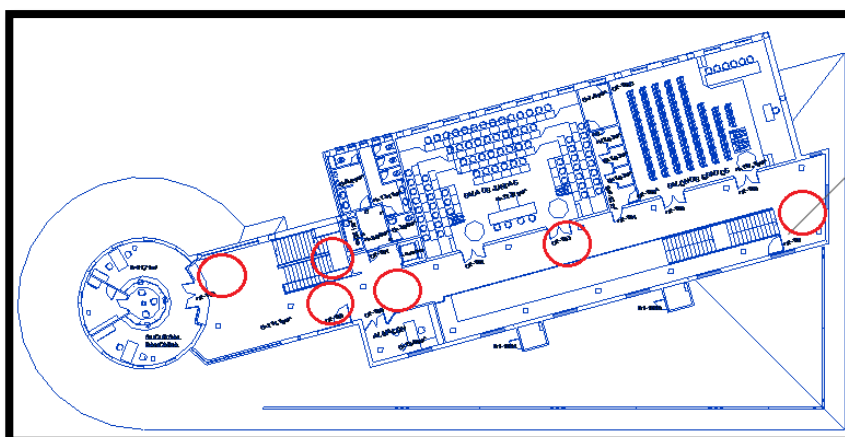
Zonas propuestas del láser escáner en la Primera Planta
